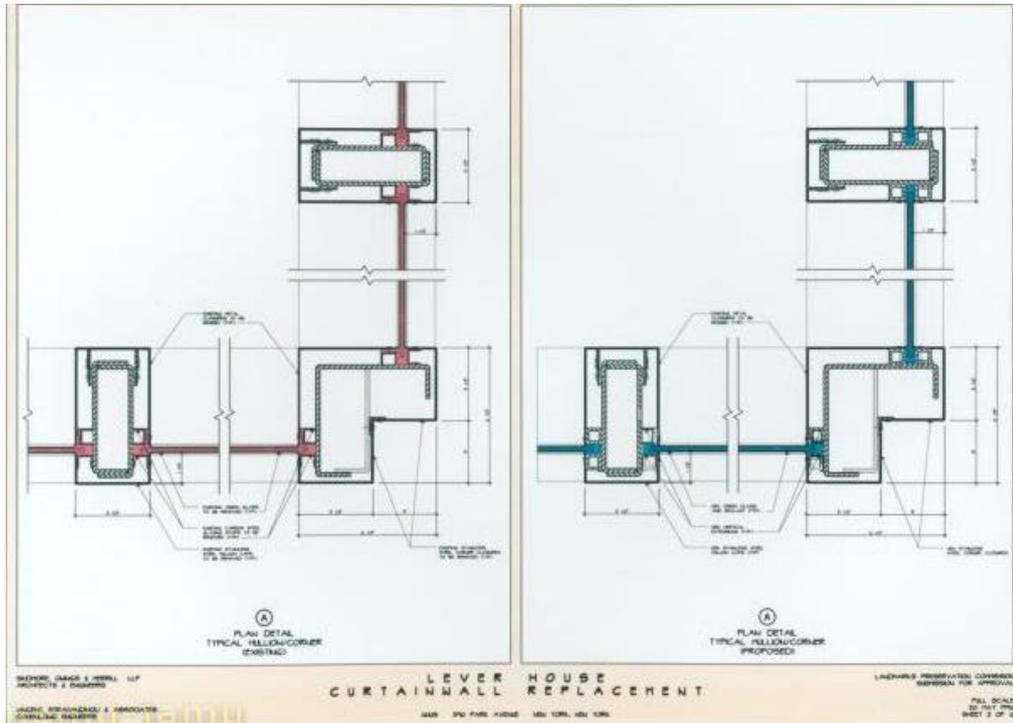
Curtain wall* pada bangunan Lever House.
